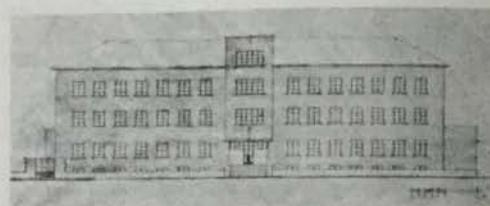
a - Convitto Biellese - I progetto: prospetto sulla via Tripoli.
